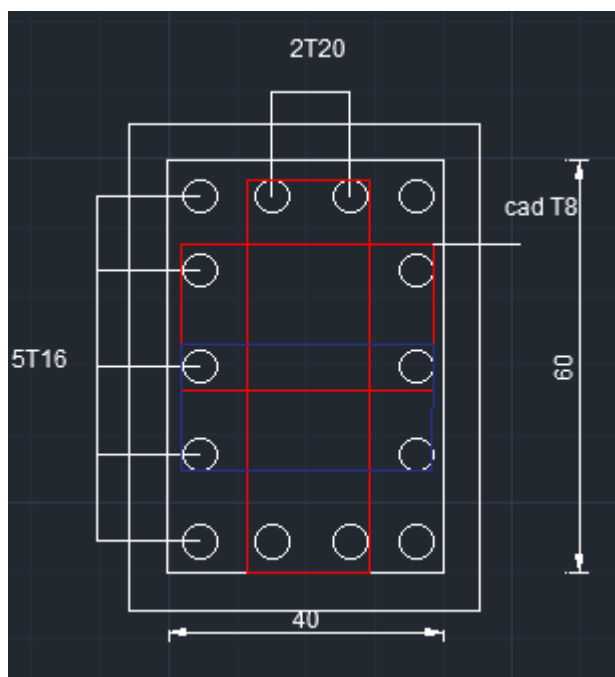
Ferrailage d'un poteau 40x60cm.
